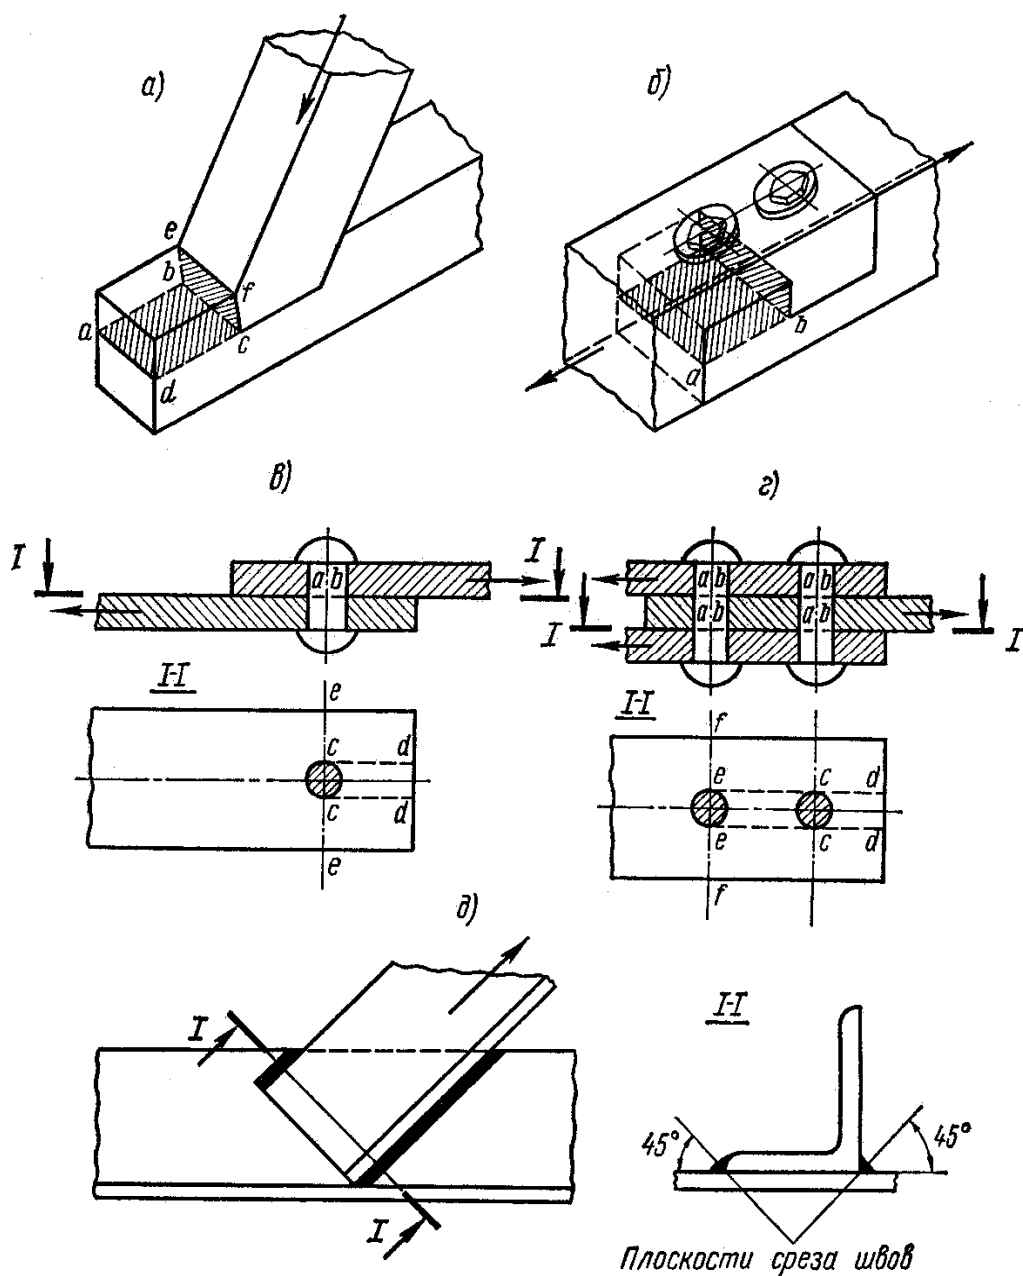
Конструкции, рассчитываемые на сдвиг: *а, б* – деревянная врубка; *в, г* – заклепочное соединение; *д* – сварное соединение.
